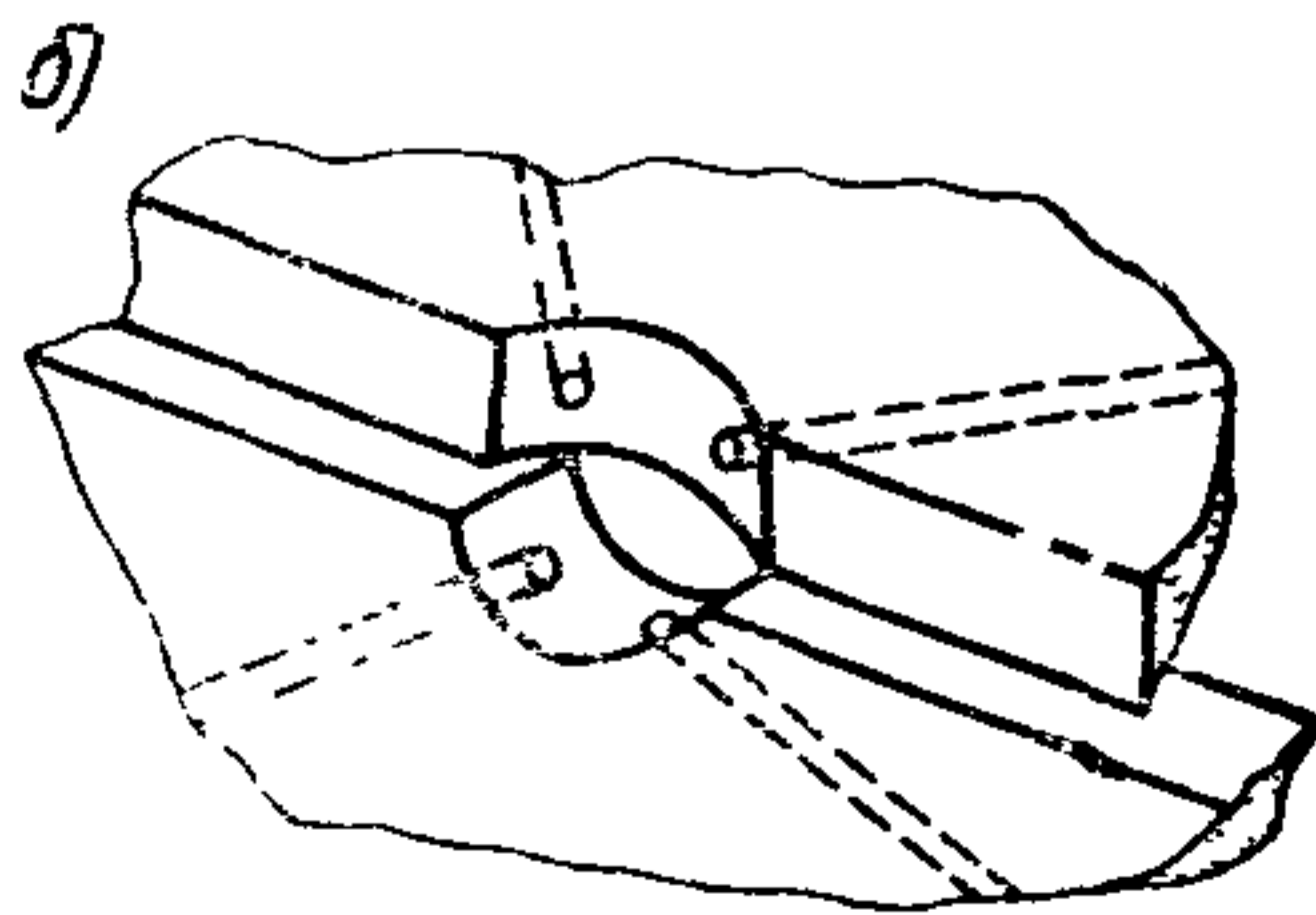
Пример выполнения электропроводки в каналах крупнопанельного жилого дома с монолитными железобетонными панелями (здание серии 1-464А):
